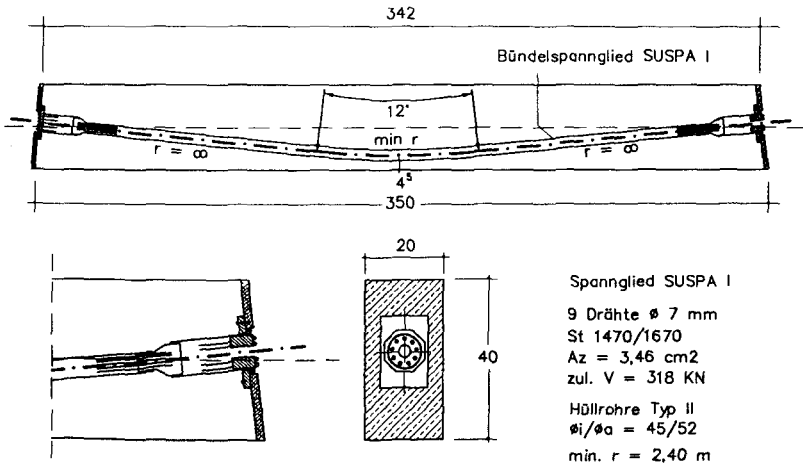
Schalplan mit Spanngliedführung zur Versuchsserie B
